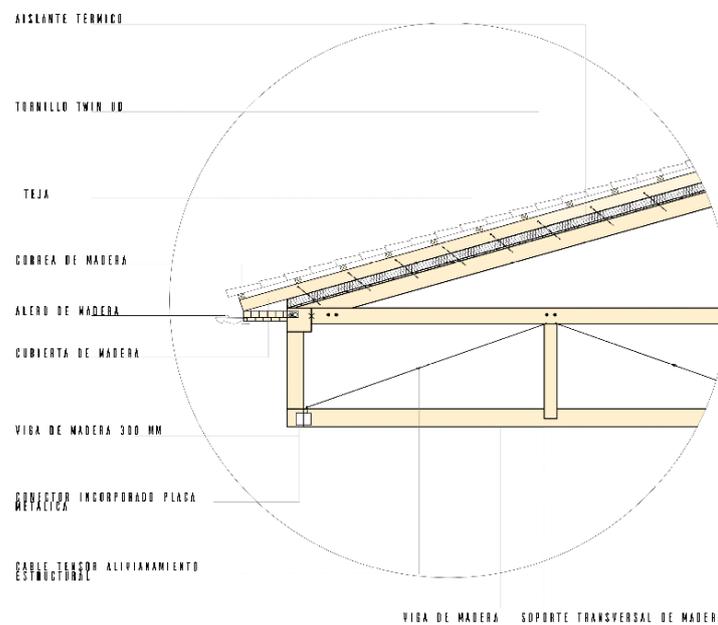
Detalle de Cubierta Nave Iglesia Primitiva. Elaboración propia.
